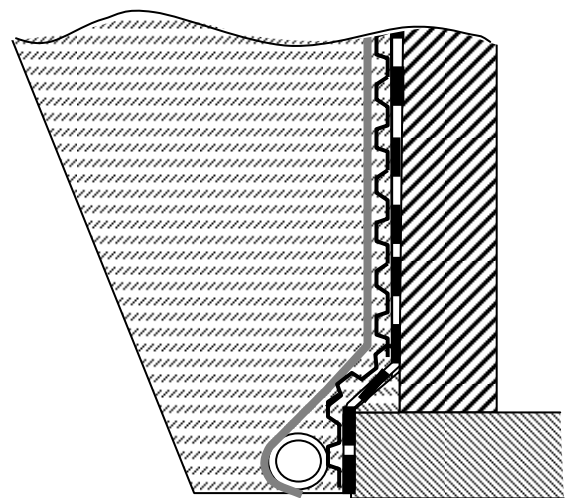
Coupe de mise en œuvre étanchéité + DRAINAX G (cas où le drainage est obligatoire)
